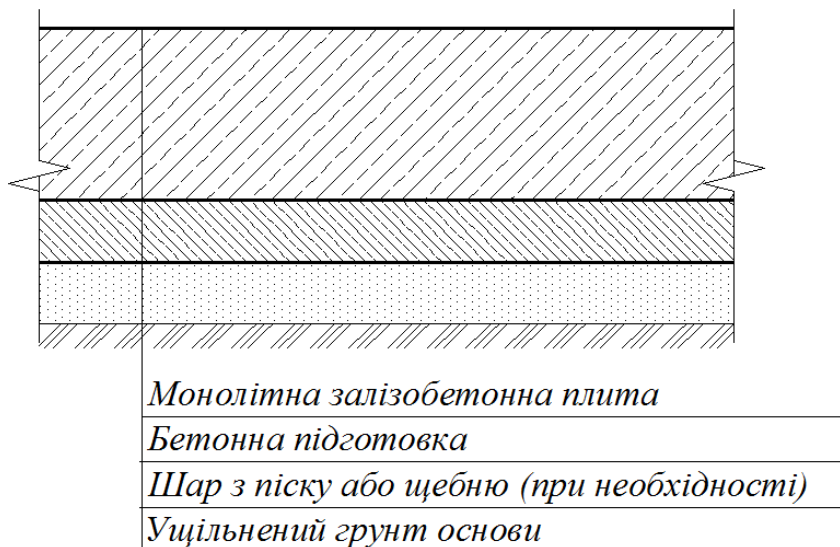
Підлога по ґрунту з влаштуванням бетонної підготовки
